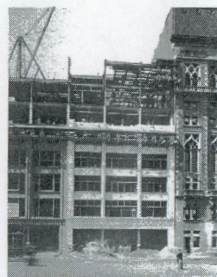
Holabird and Roche, Gage Building, 18-22 South Michigan Avenue; Fassade von Louis H. Sullivan; während der Bauarbeiten, 11. August 1899 (verändert)
